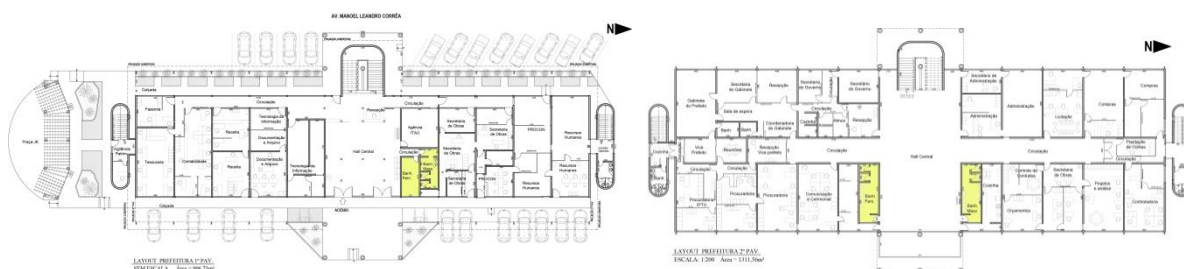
Localização dos banheiros no 1º e 2º pavimentos, respectivamente.
